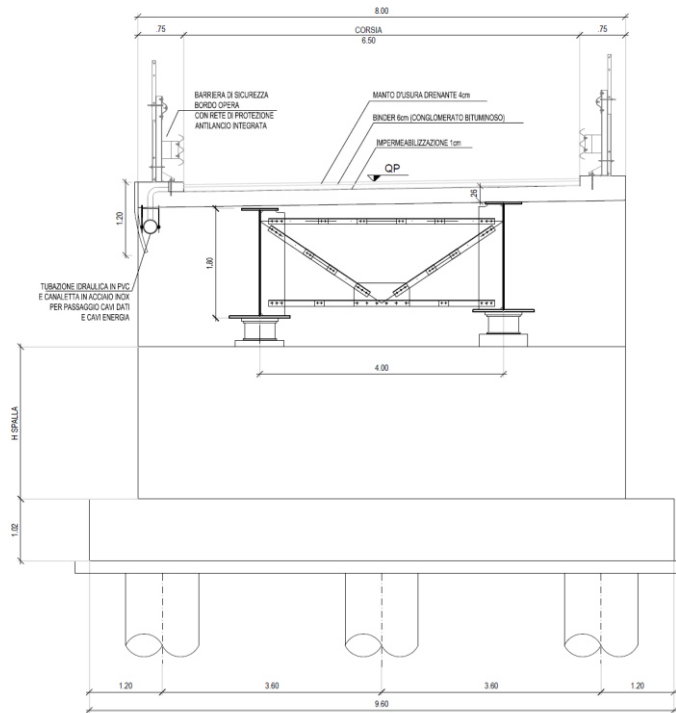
Sezione trasversale impalcato viabilità secondaria
